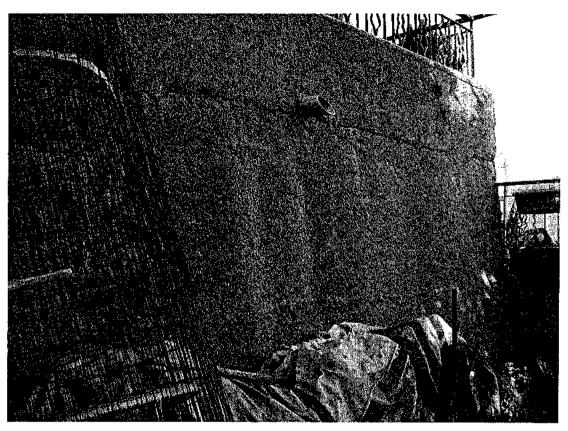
Muro di sostegno a tergo del terrazzo con distaccamento del parapetto
